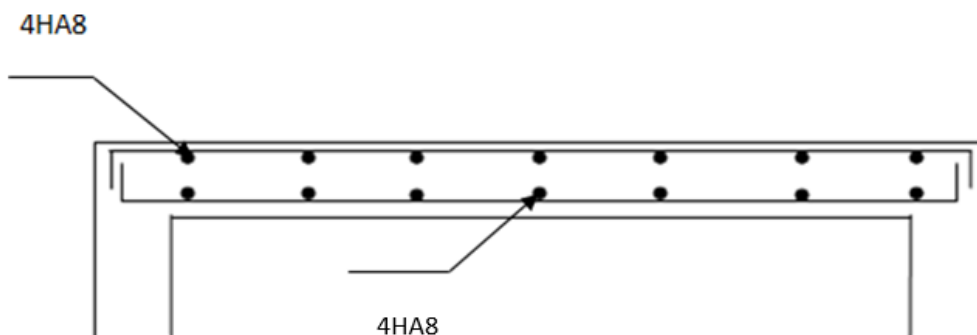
ferrailage de la dalle salle machine sens X-X et Y-Y
